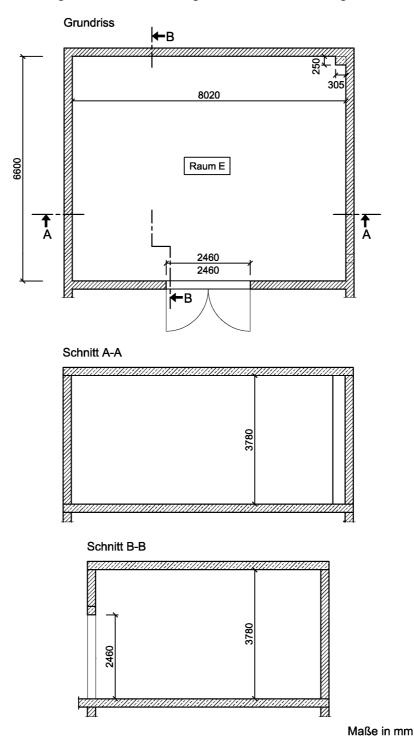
Grundriss und Schnitte des Hallraums.
